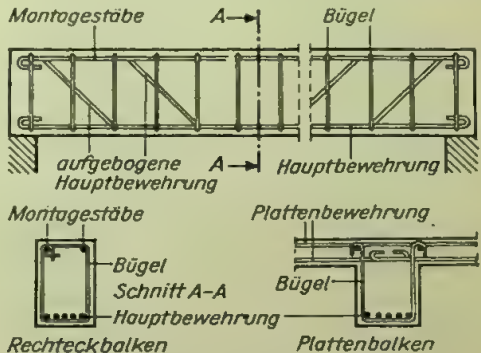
Bewehrung eines Stahlbetonbalkens mit Rechteck- und Plattenbalkenquerschnitt
